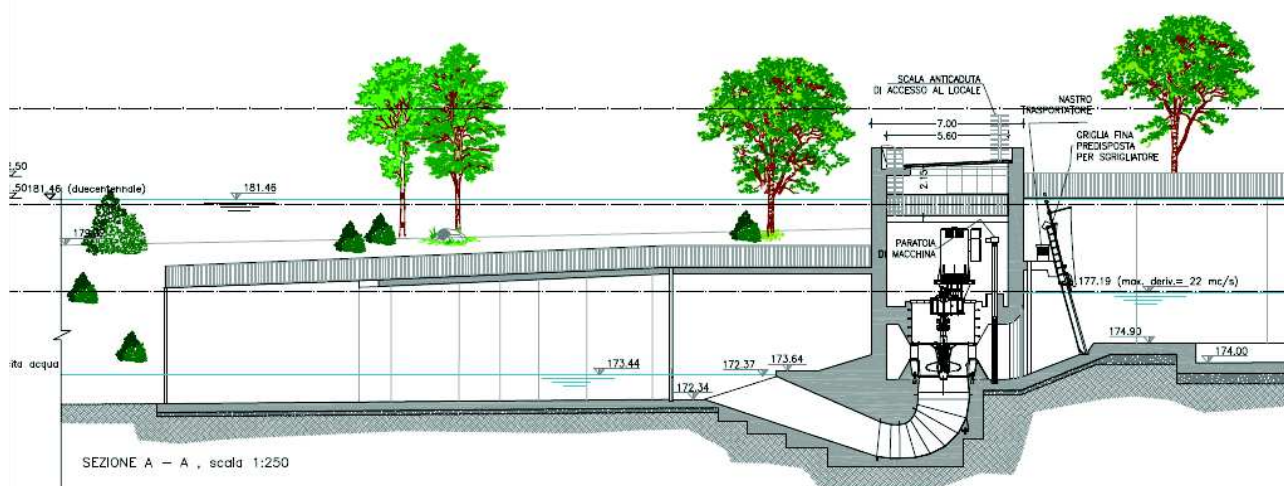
Estratto Tav. 08 Stato di progetto Sezione relativa alla centralina
